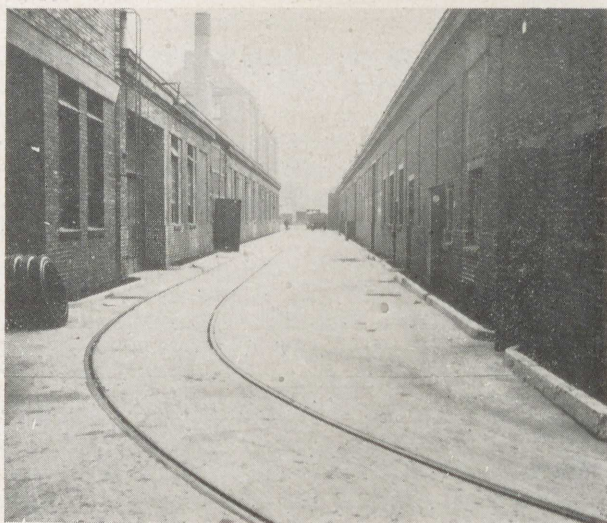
Betonstraße der Berliner Verkehrs A. G.
